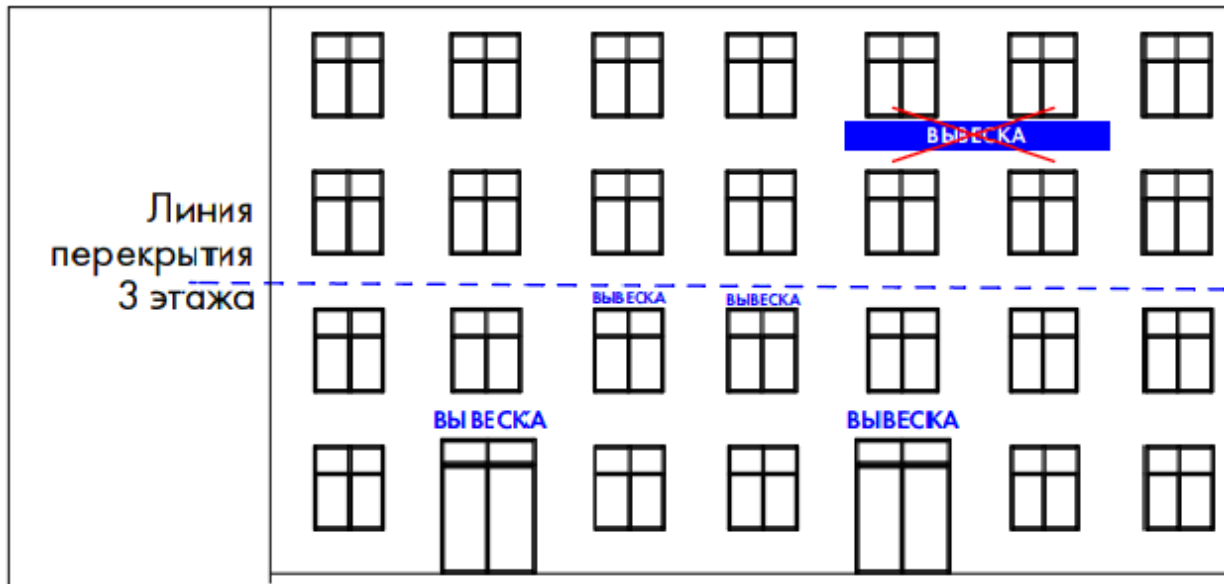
Недопустимое размещение информационных конструкций и иных конструкций на нежилых зданиях высотой от трех этажей
